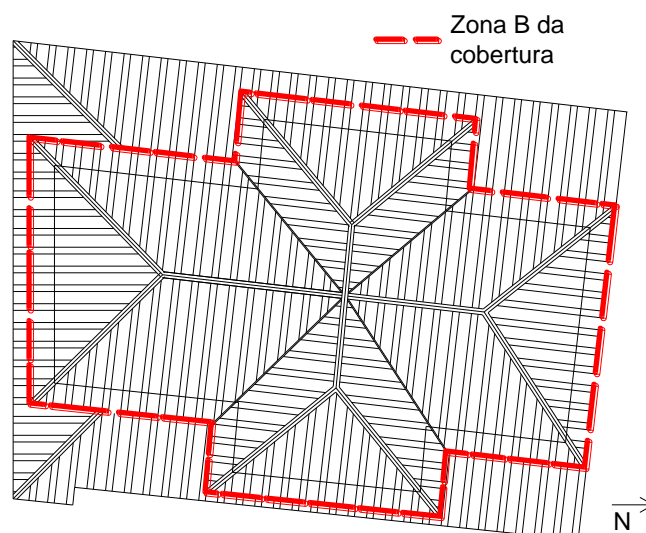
Planta da Zona B da cobertura (adaptado de [9])
